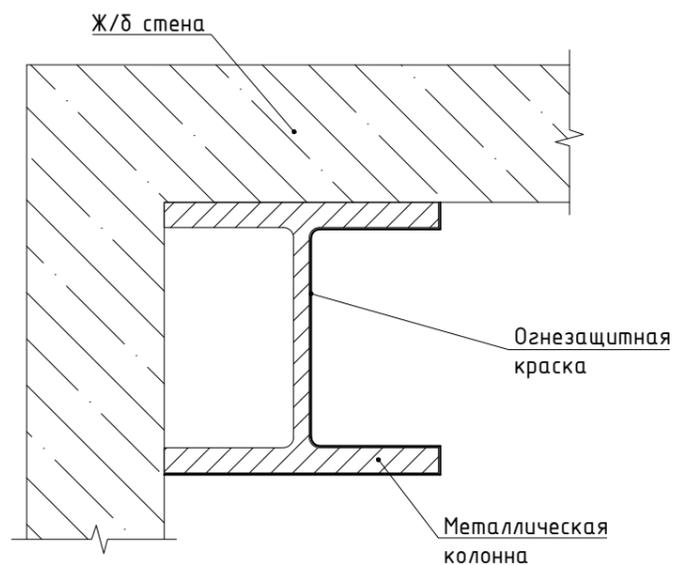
Огнезащита краской металлической колонны, двумя сторонами примыкающей к железобетонной стене
